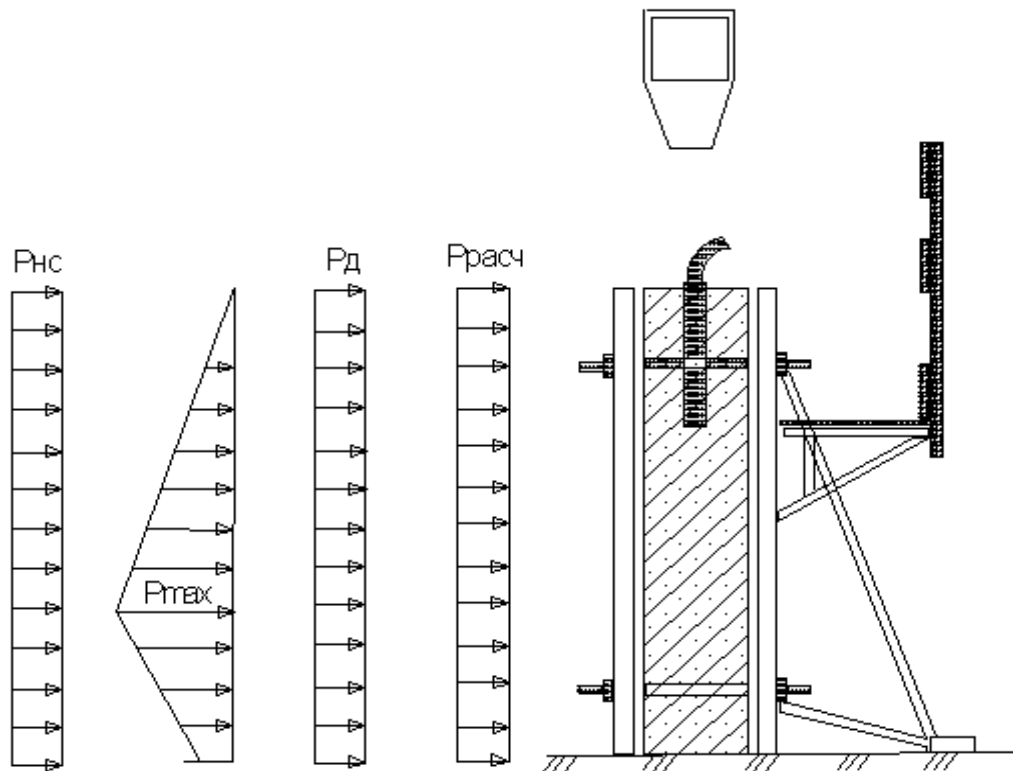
Расчетно-конструктивная схема опалубки стен
